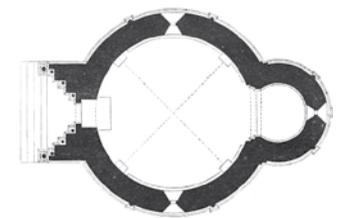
Grundriss, MdkkCC 1886, 150. M 1:400.
